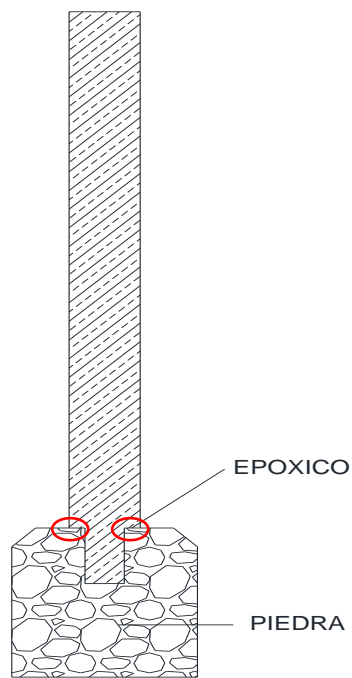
Esquema de la base de piedra (Elaboración propia en AutoCAD, 2019)
